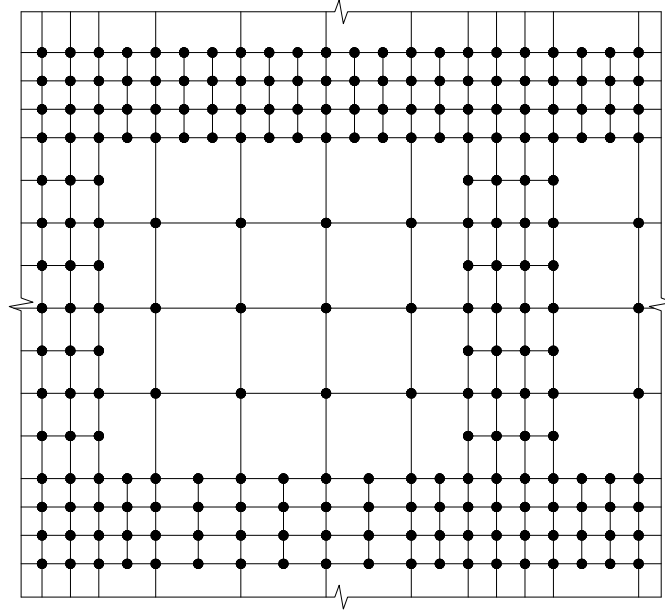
模板支撑架立杆间距成倍数设置平面图
